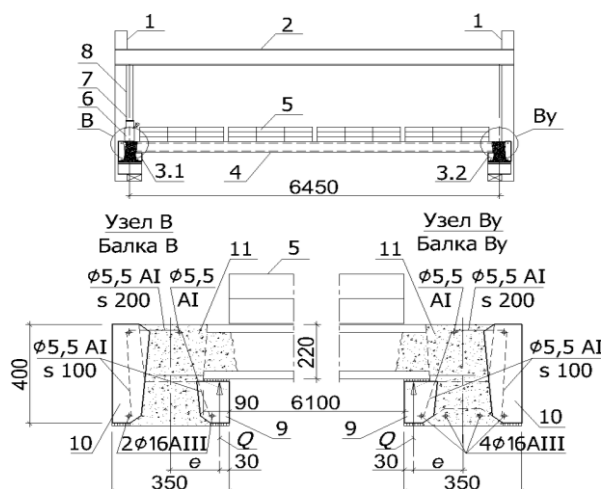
Схема испытания пары *СбМт* балок серии *В*, поясов наружных стен: 1 – рама испытательного стенда; 2 – вспомогательная балка стенда; 3.1 – *СбМт* балка пояса *В*; 3.2 – тоже - *Ву*; 4 – настил из круглопустотных панелей перекрытия; 5 – постоянная нагрузка; 6 – траверса на подвижных опорах; 7 – гидравлический домкрат; 8 – насадка; 9 – опорная ветвьбалка; 10 – ограждающая ветвьбалка; 11 – монолитный сердечник [разработка автора].
